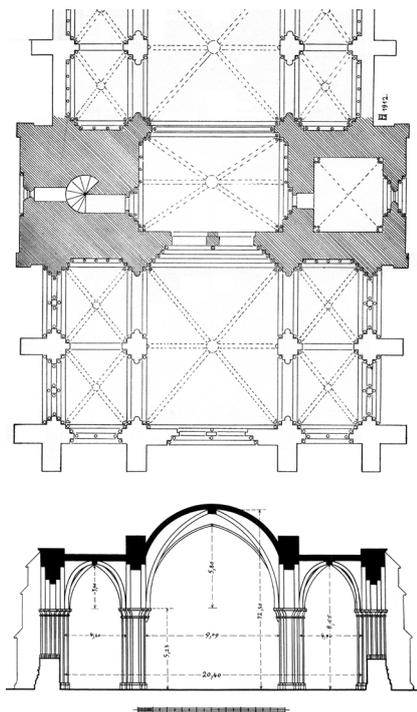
Rekonstruktion der geplanten Vorhalle am Halberstädter Dom in Grundriss und Schnitt nach Giesau. Aus: Giesau 1912, (vgl. Anm. 24).
